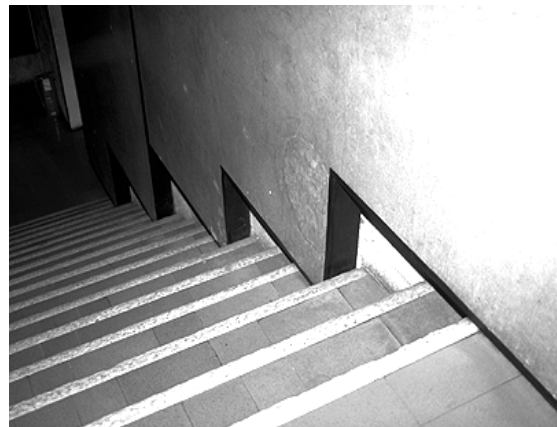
Caserma, Paneele im Treppenabgang zum Erdgeschoß, Detail Treppenstufen, Wandpaneele
